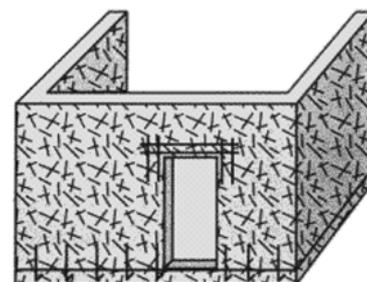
Stahlfaserbeton in Fundamentplatte und Kellerwand
